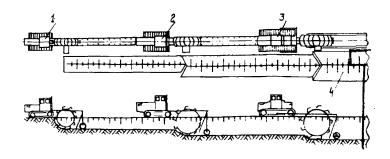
Последовательная разработка траншен для трубопровода диаметром 1420 мм роторными экскаваторами: І-роторный экскаватор ЭР-7Е; 2-ЭТР-231; 3-ЭТР-253; 4-отнал грунта из траншен
